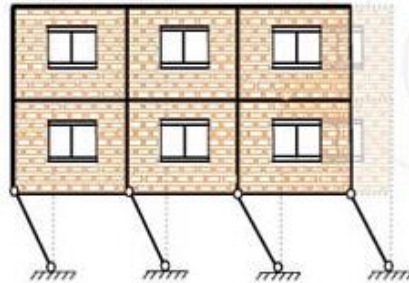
Falta de rigidez lateral y discontinuidad de elementos.
